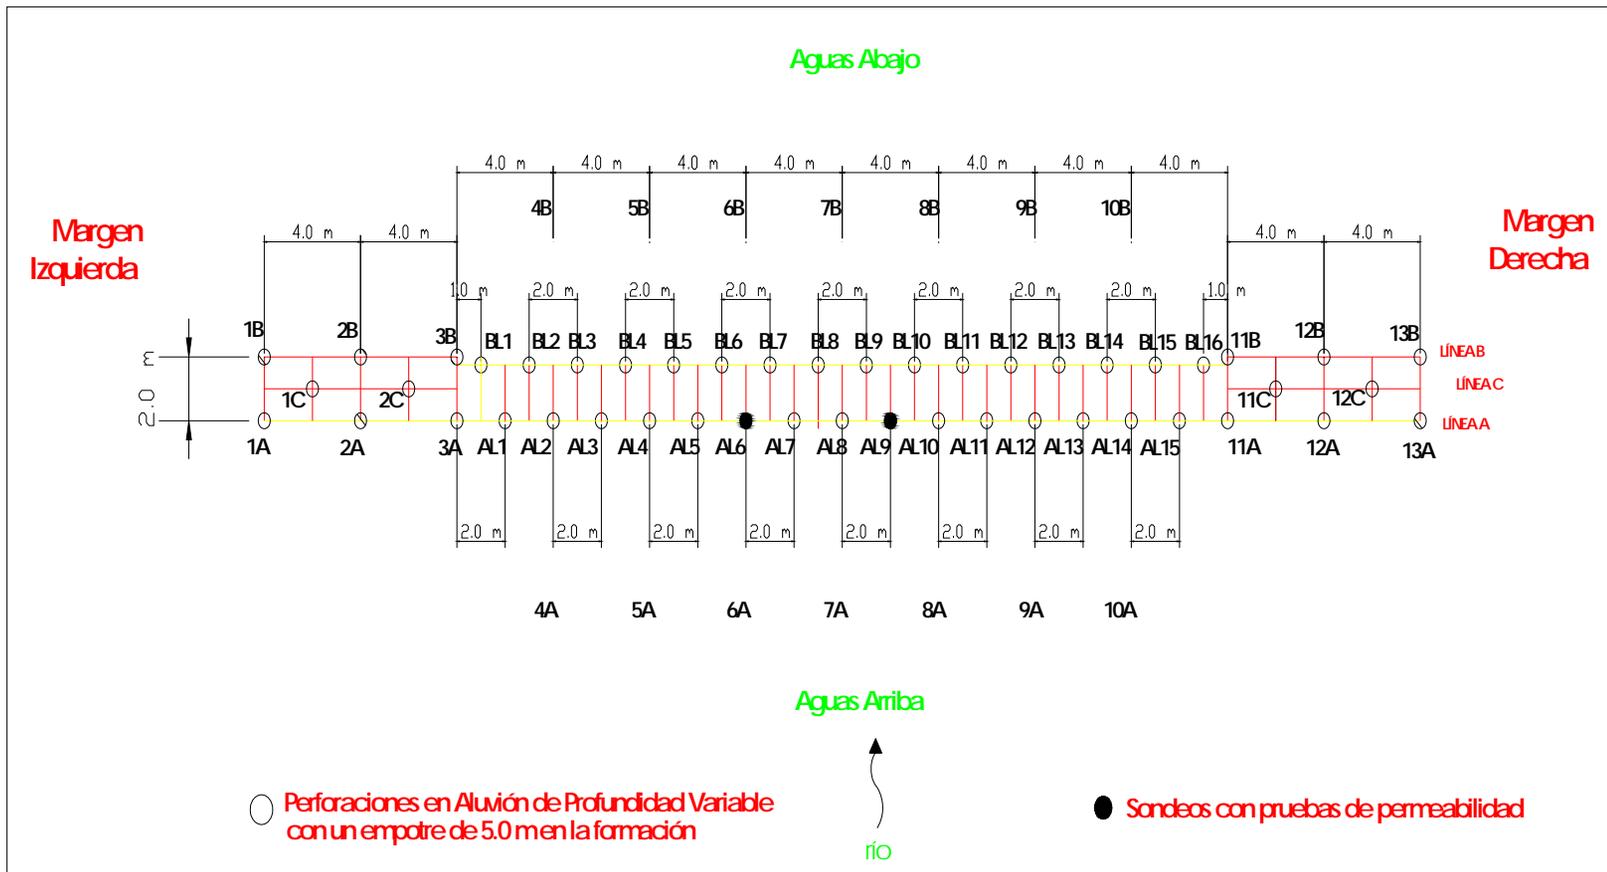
Localización en planta de los barrenos de las líneas A y B de la pantalla impermeable de la P.A. Socavones
